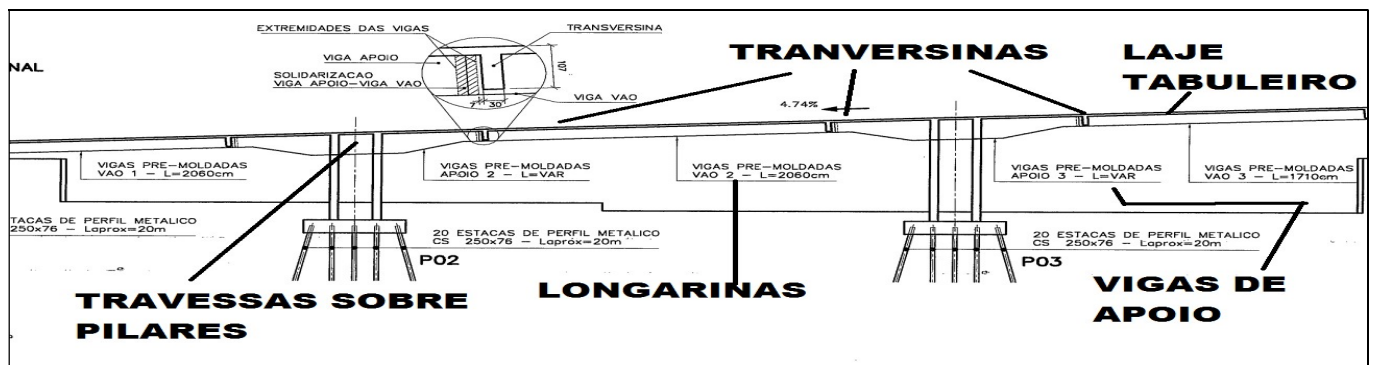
Detalhes da estrutura (Projeto DNER – Folha 02/34)
